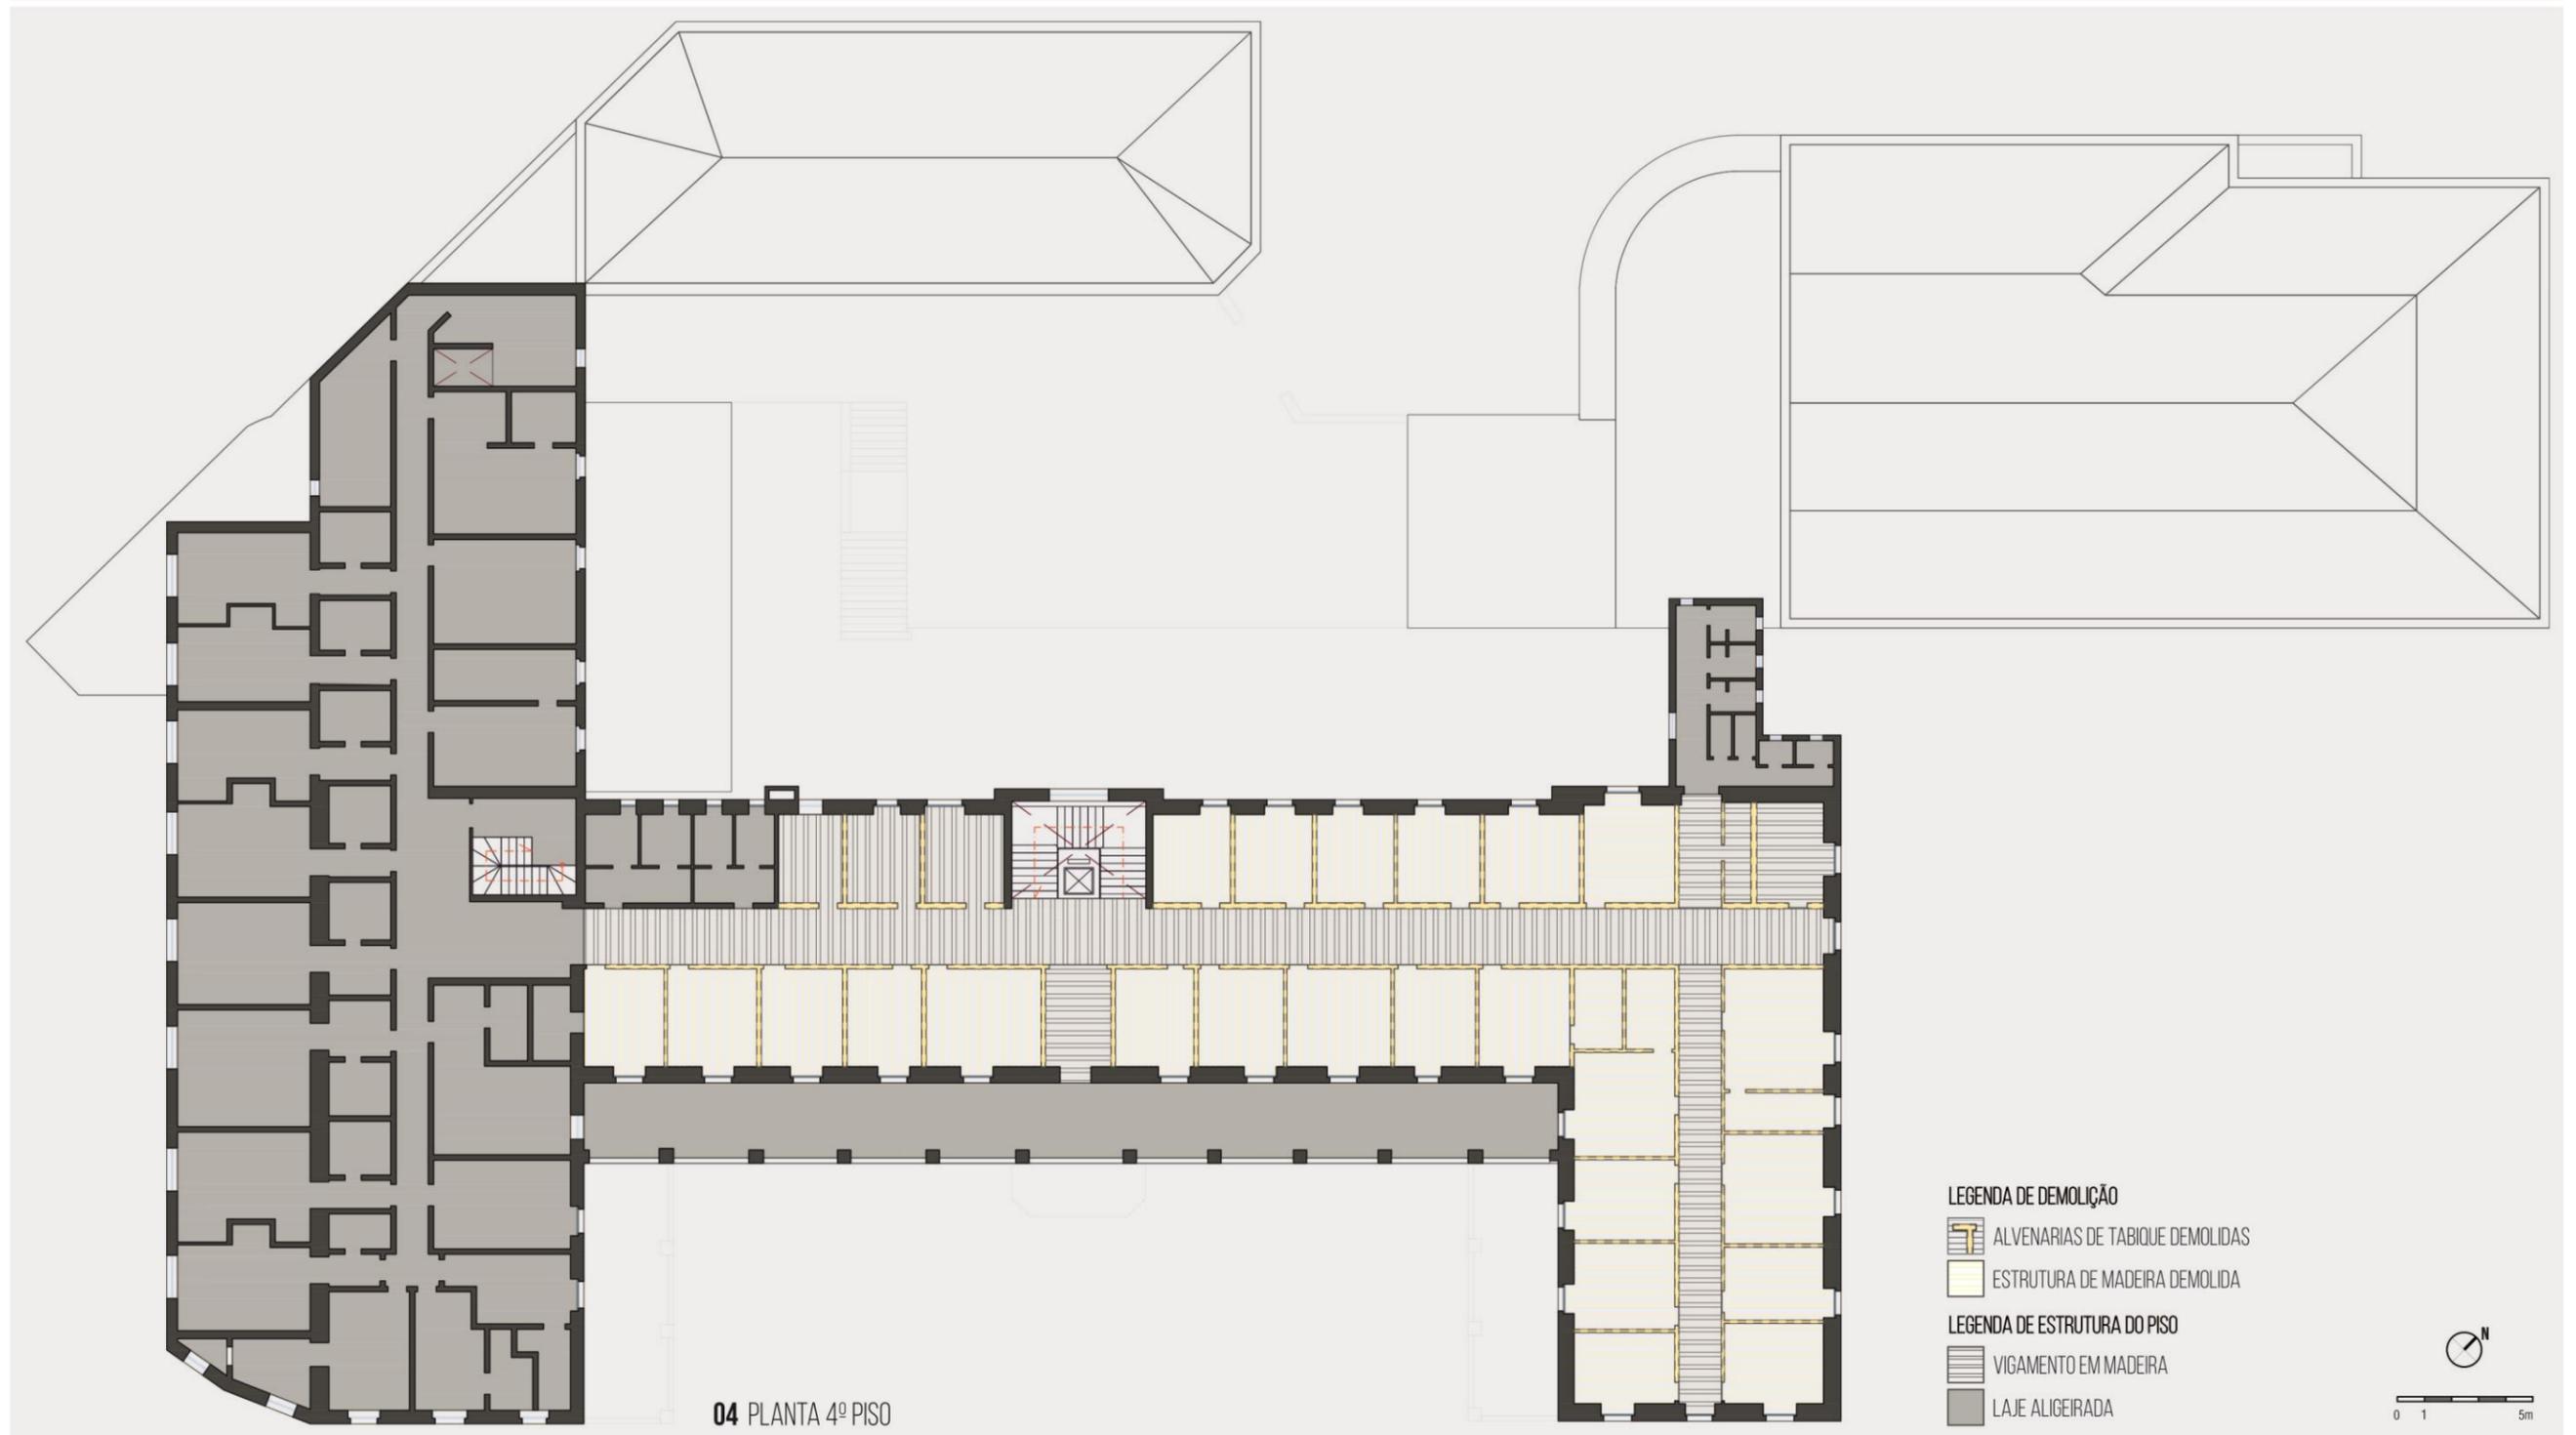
Planta de Estrutura do Pavimento – 4º Piso
